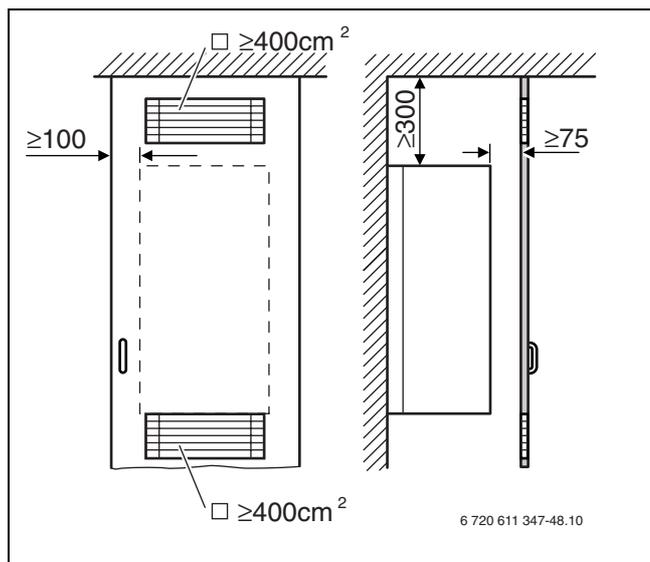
Aperture di ventilazione in caso di installazione in un armadio
